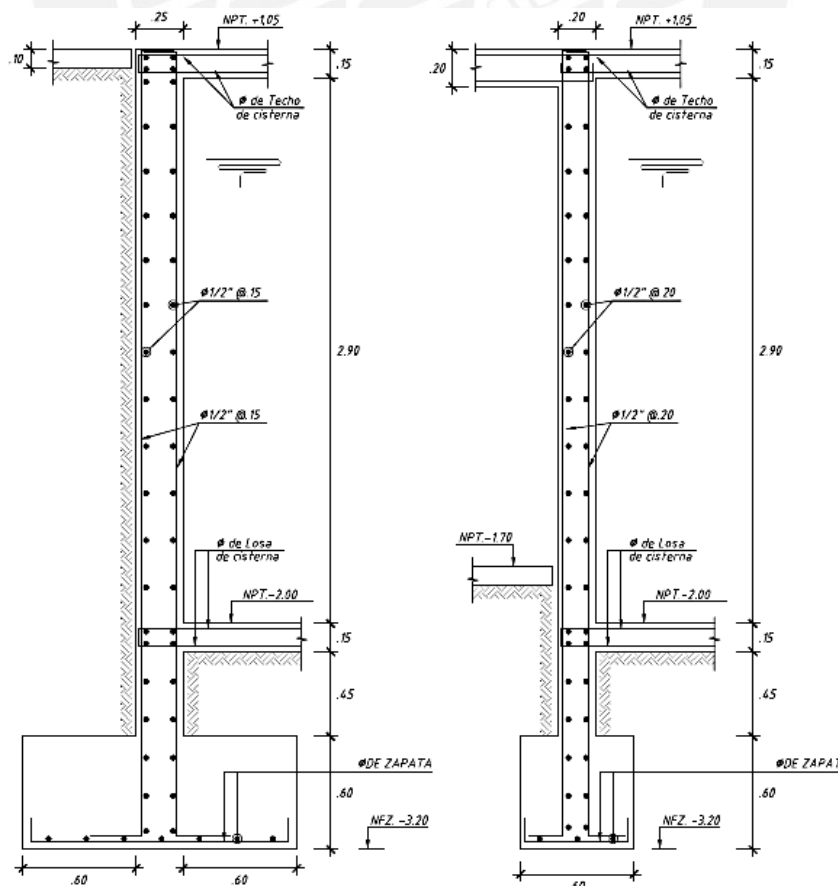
Cortes de la cisterna mostrando el armado del refuerzo.
